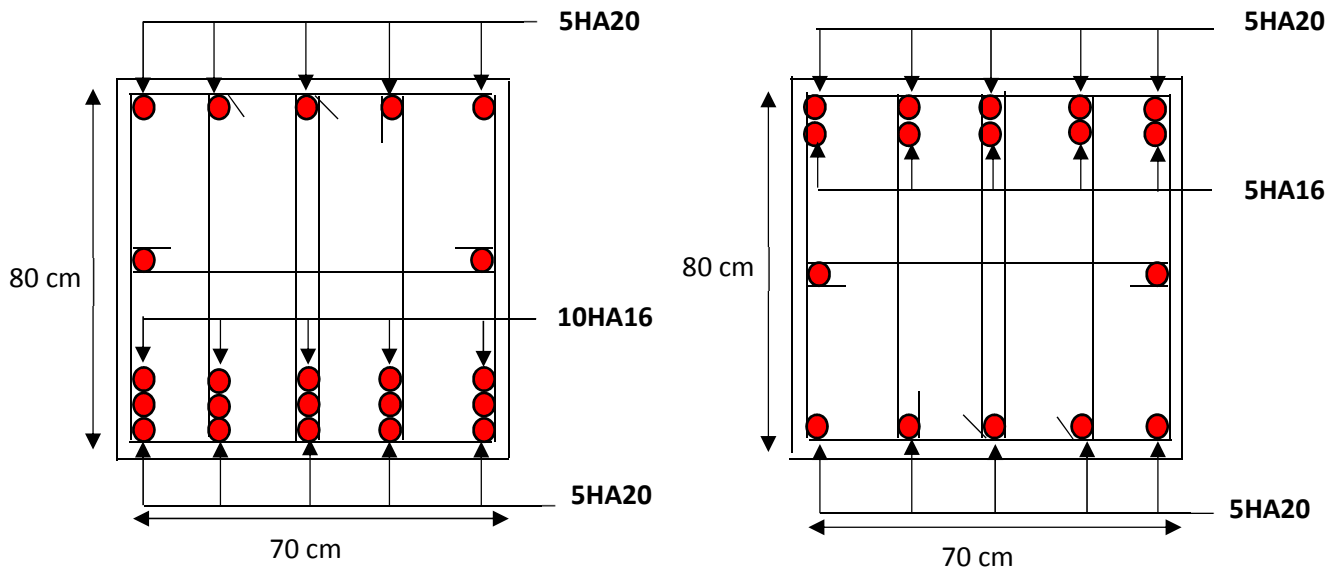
Schéma de ferrailage de la poutre de Rigidité
